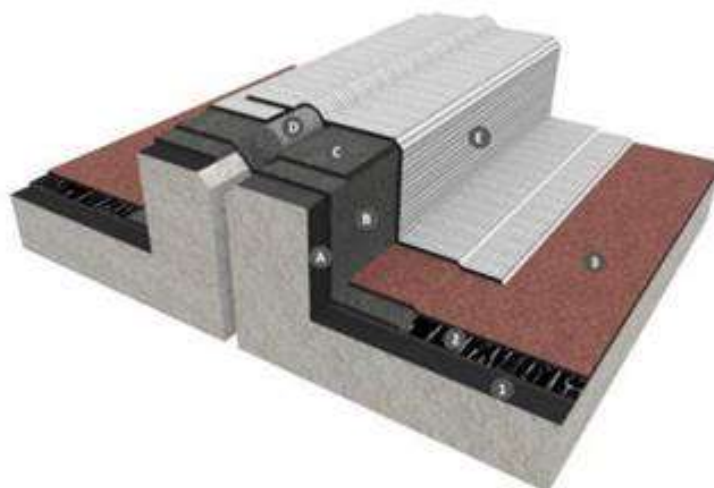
Exemple de joint plat surélevé — Terrasse avec protection par dalles sur plots avec pose directe des plots sur le revêtement d'étanchéité
